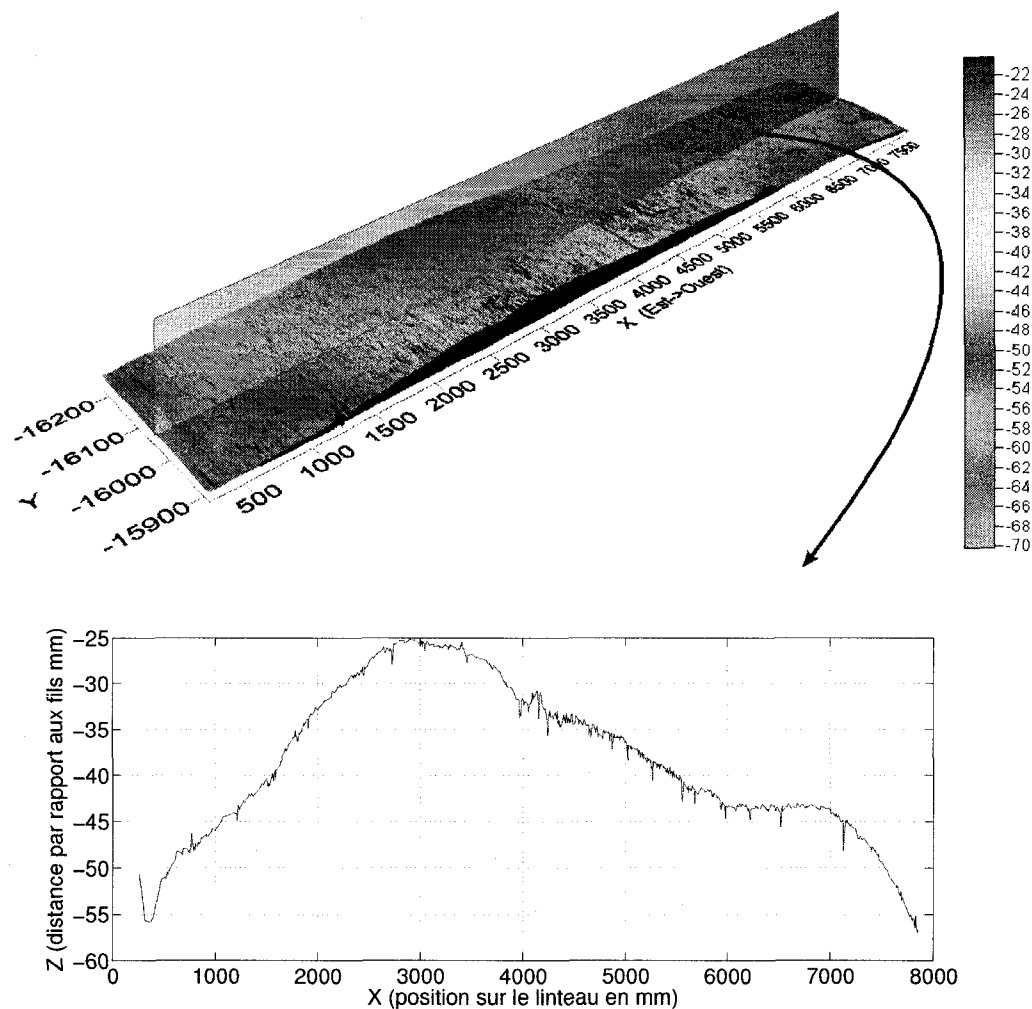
Une reconstruction de la surface du linteau 2A avec coupe longitudinale dans la surface d'est en ouest à un niveau de 16072 mm au dessus du niveau de la mer. (Unités : mm)
